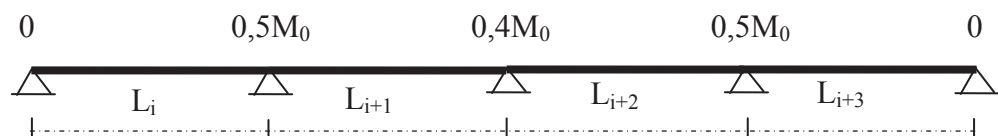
Schémas statique d'une poutrelle a plusieurs travées
